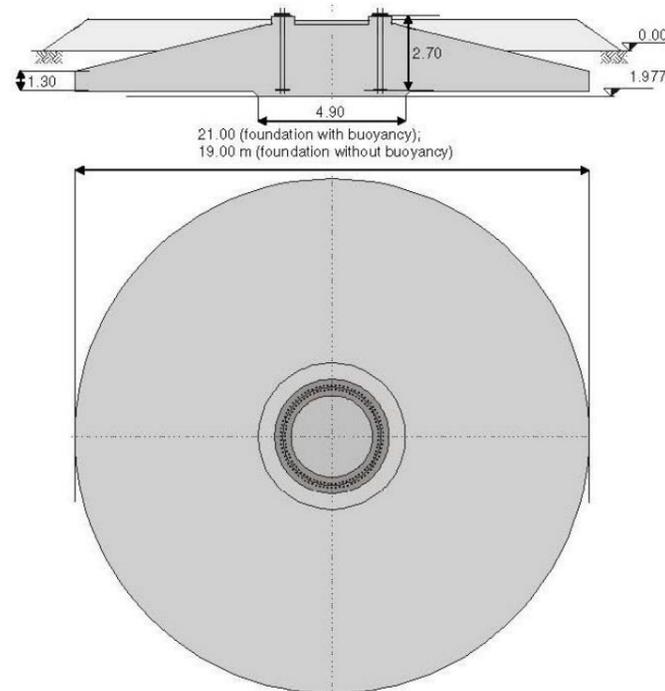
Vue en coupe des fondations (source : Nordex, 2013)
